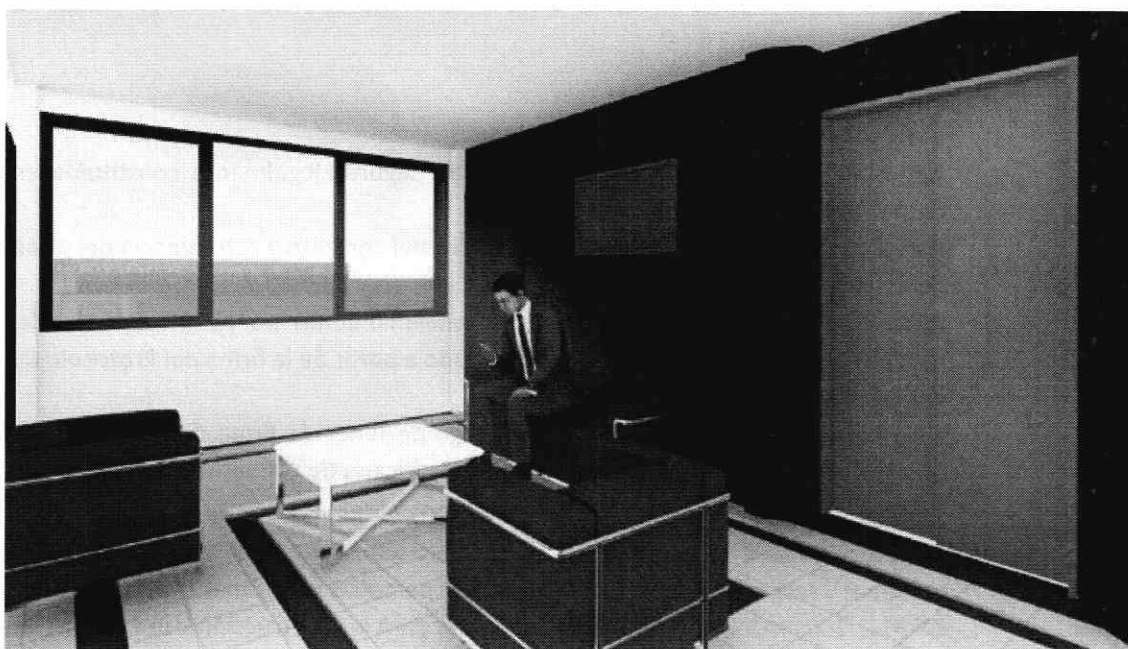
Propuesta arquitectónica para pasillos con mármol estampillado
